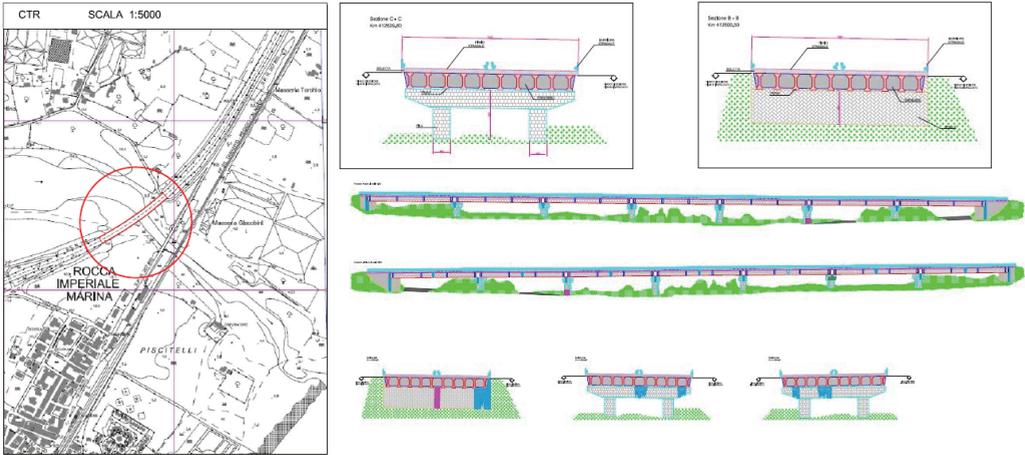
Planimetria, sezioni trasversali, prospetti e zone di degrado nel ponte di figura 2.
